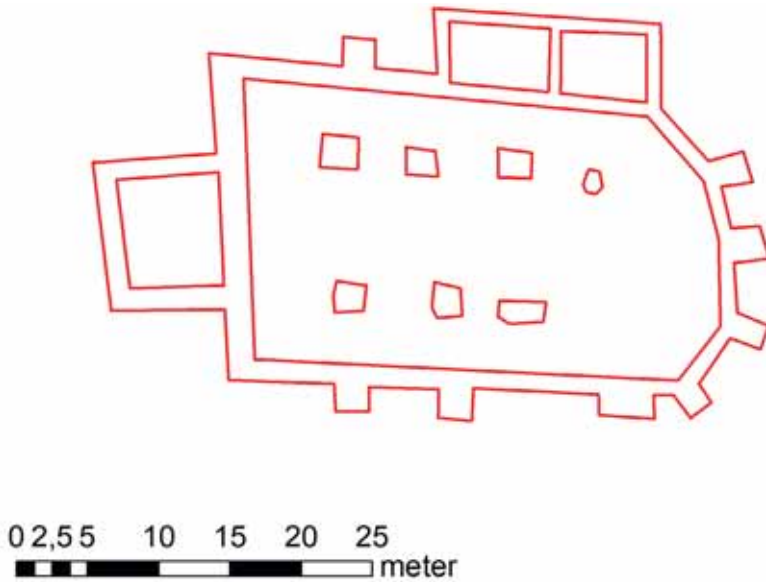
Planritning över kyrkans utseende omkring år 1600. Plan: Christina Rosén 2020. – Plan drawing of the church c. 1600.
